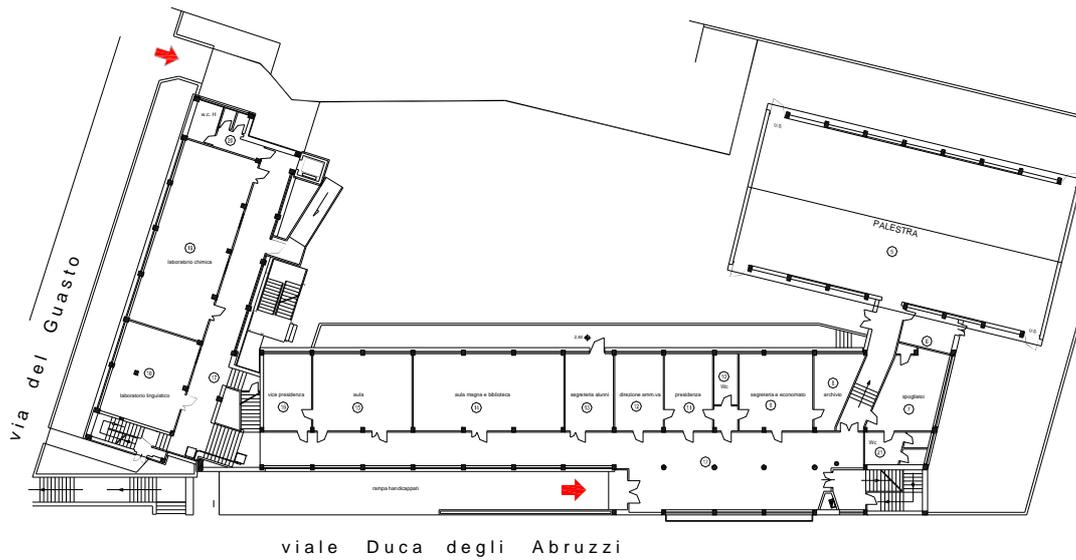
Pianta Piano Terra (aule, laboratori, palestra).
